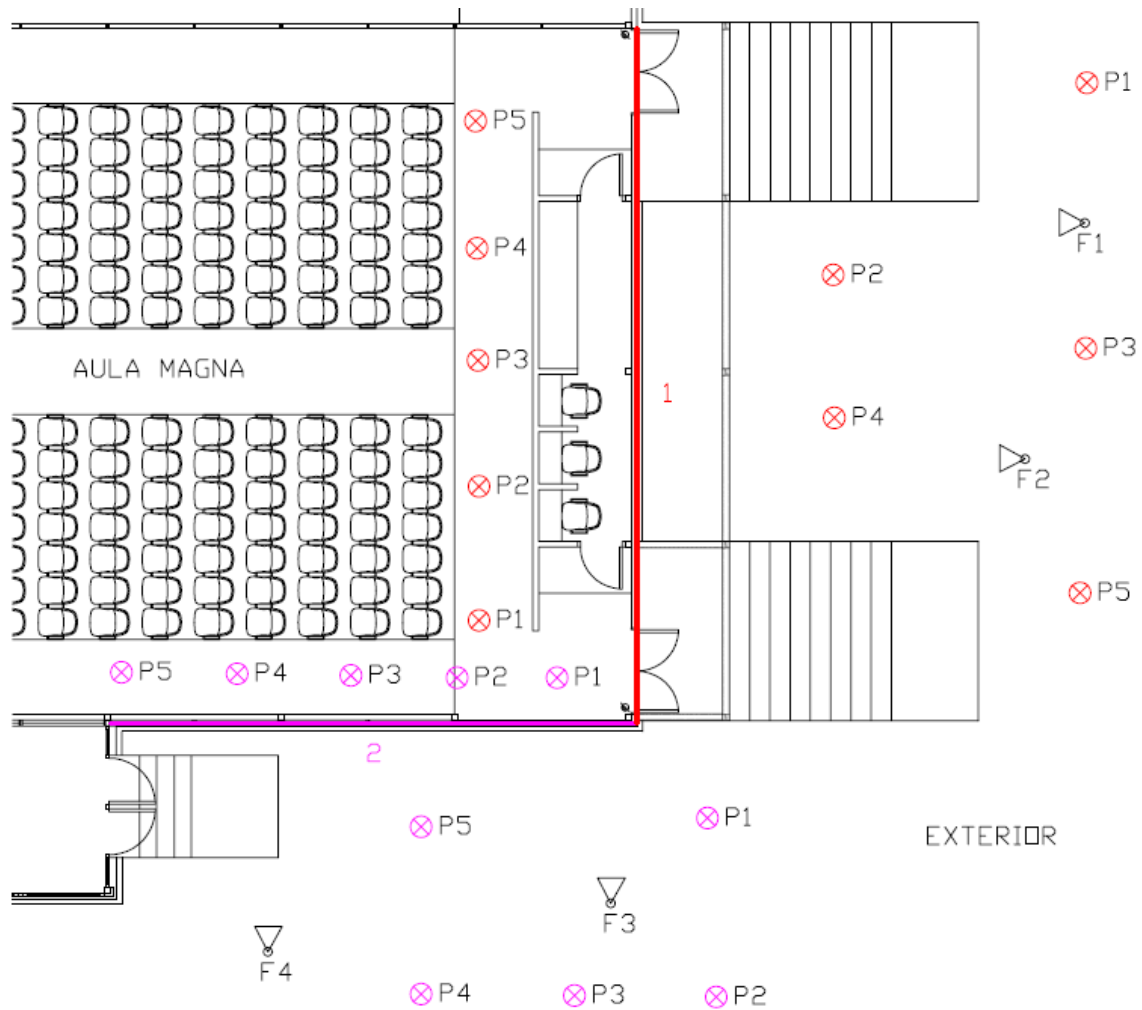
Plano de posición de medidas para cálculo de aislamiento a ruido aéreo de fachadas.
